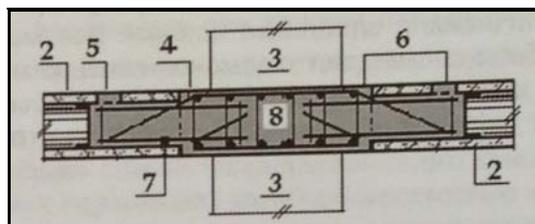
Сечение 1-1 на рис. 2 для варианта с монолитным исполнением плитного ригеля со скрытыми опорными консолями, вписанного в толщину перекрытия
